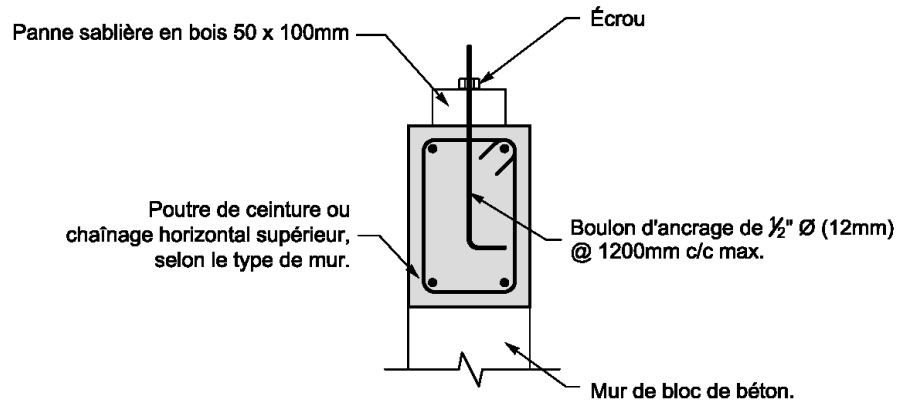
Ancrage de la panne sablière à la poutre de ceinture
